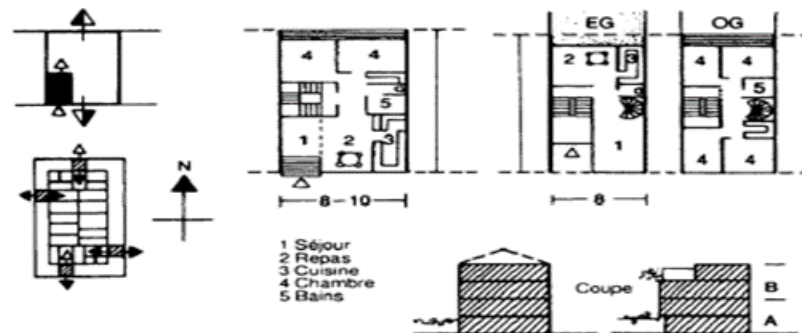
2: plan d'un seul log par étage Source: Neufert.
